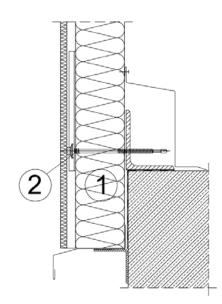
Fußpunkt Wandelement aufgesetzt Bild 7: Fußpunkt Wandelement vorgesetzt
